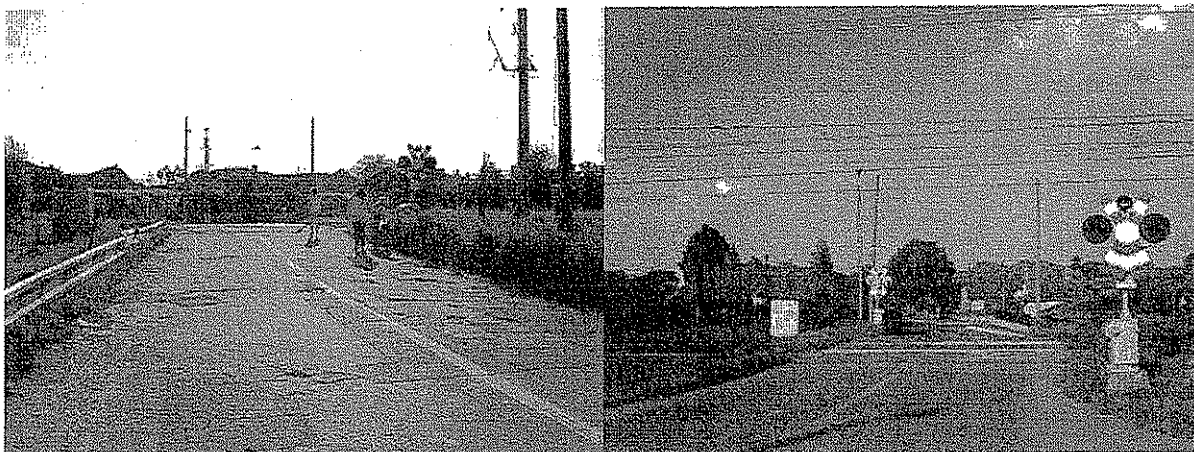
Traversare la nivel peste calea ferată - Str. Ion Rațiu
